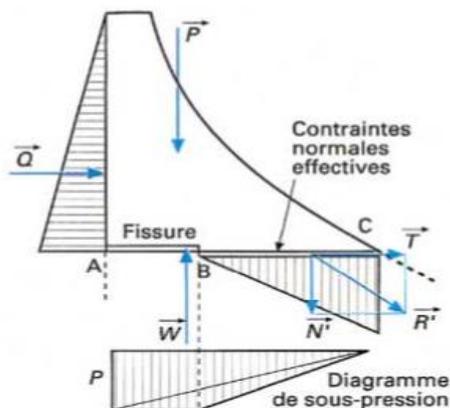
Equilibre avec fissuration (profil non drainé) (technique de l'ingénieur)
